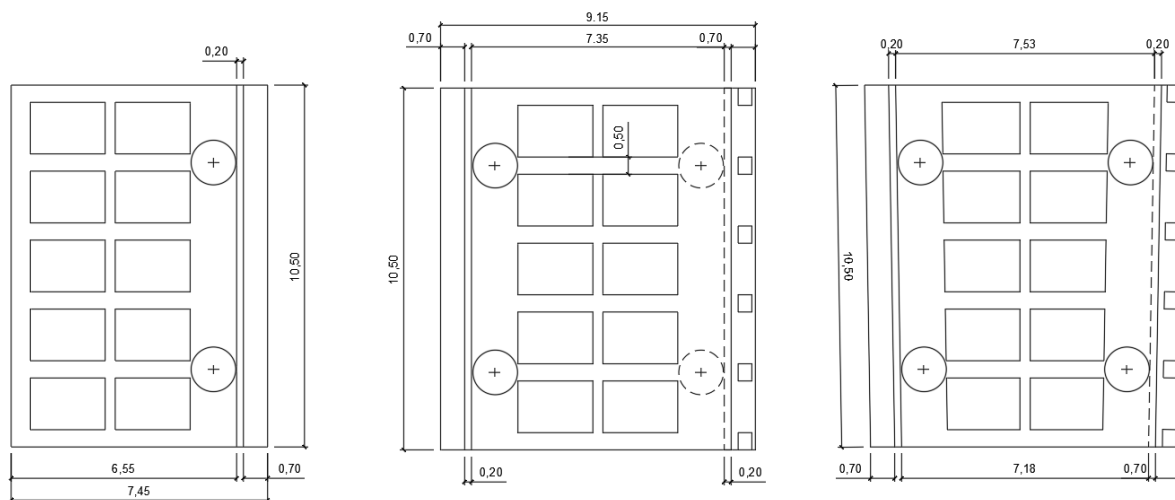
Pianta pulvini nervati - Sx su spalla S1; Centrale in rettilineo; Dx in curva
